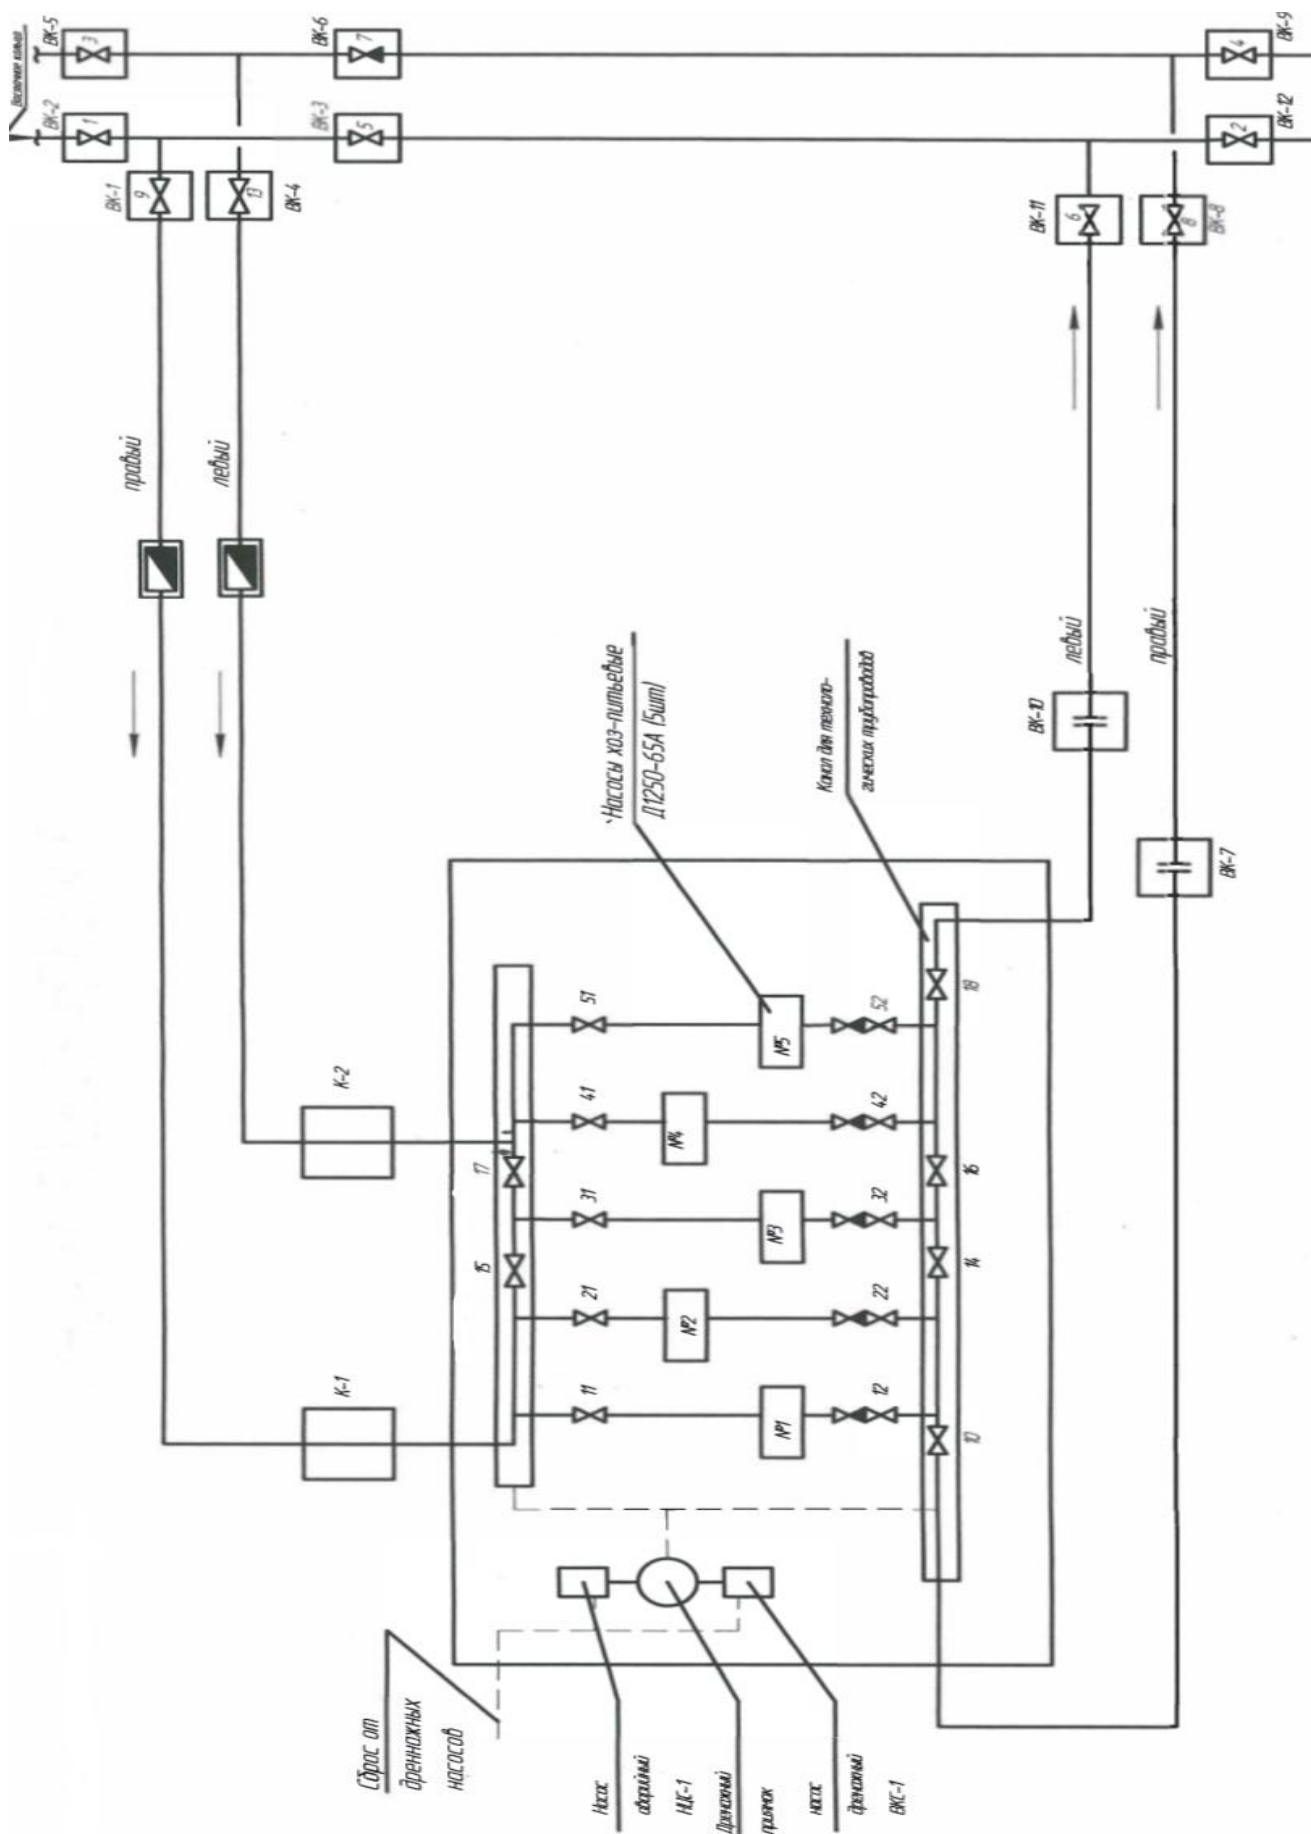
Принципиальная схема водопроводной насосной станции
